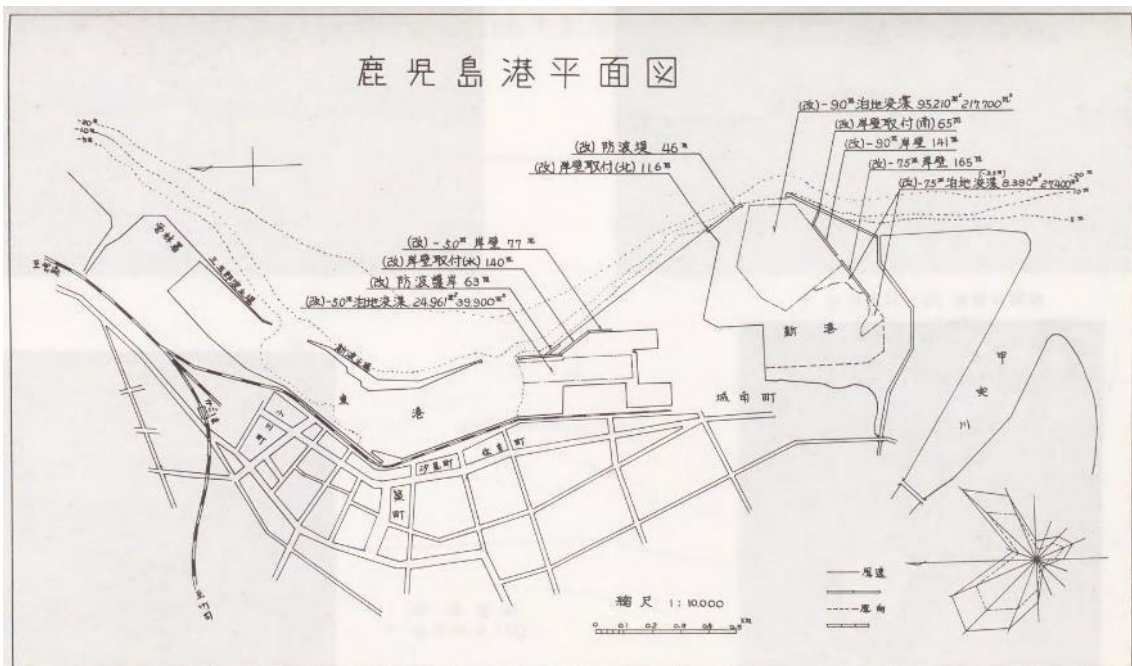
鹿児島港工事平面図 (1965年) [539, p. 60]
